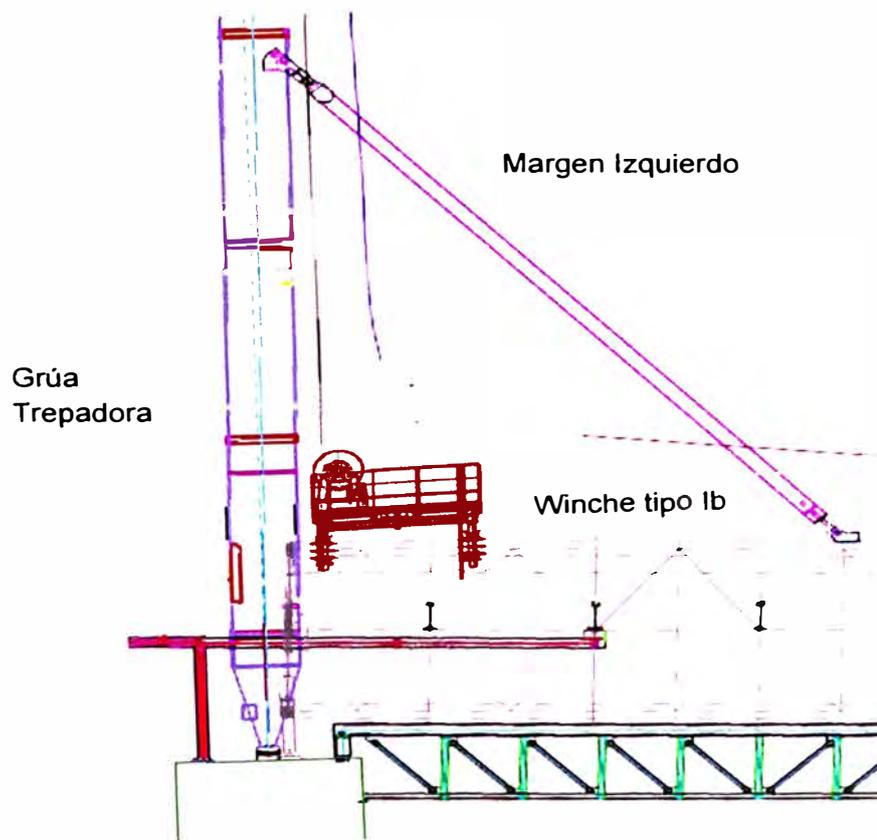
ESQUEMA TRASLADO DE CABLES DE WINCHES
